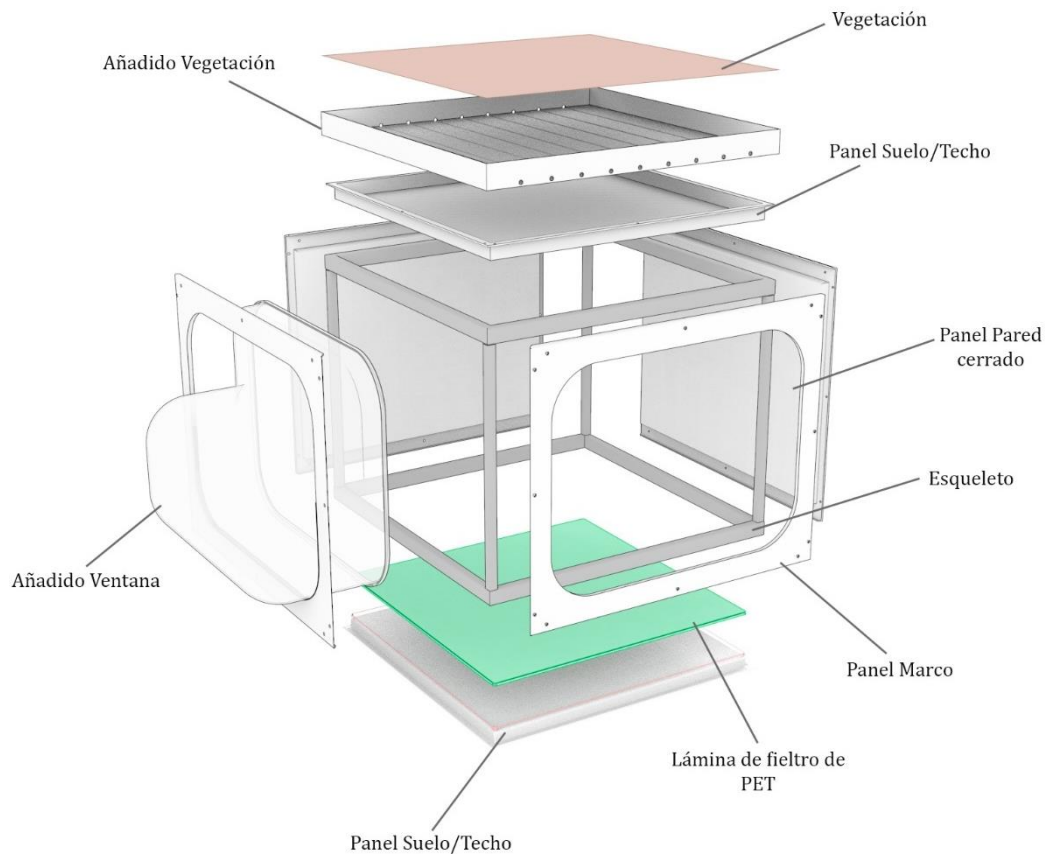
EXPLOSIONADO DE UN MÓDULO. FUENTE PROPIA.
